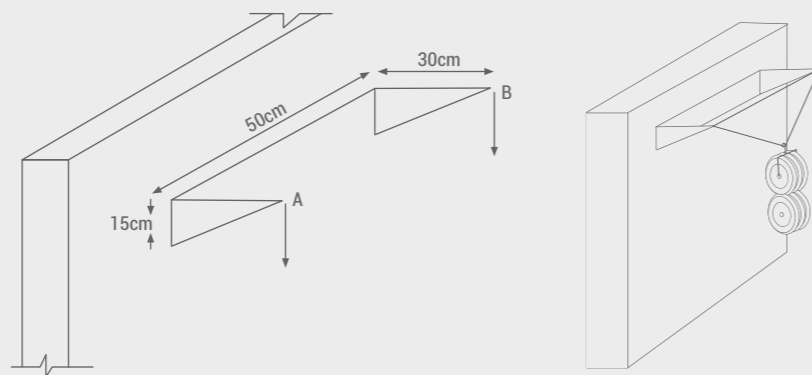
Esquema da realização do ensaio de cargas suspensas
